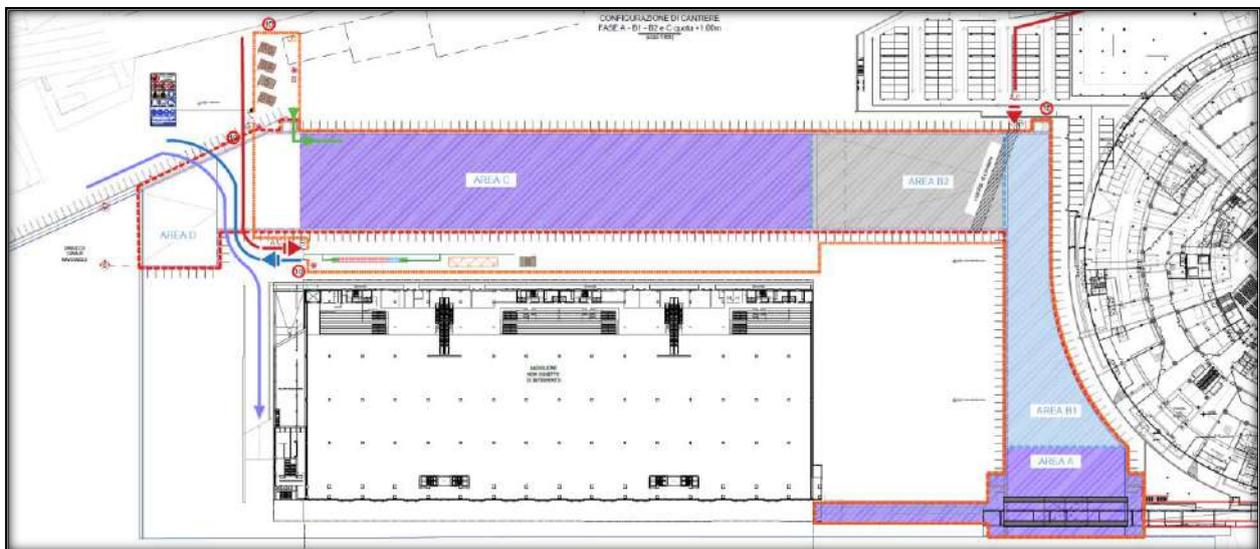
Stralcio Planimetria di Cantierizzazione
